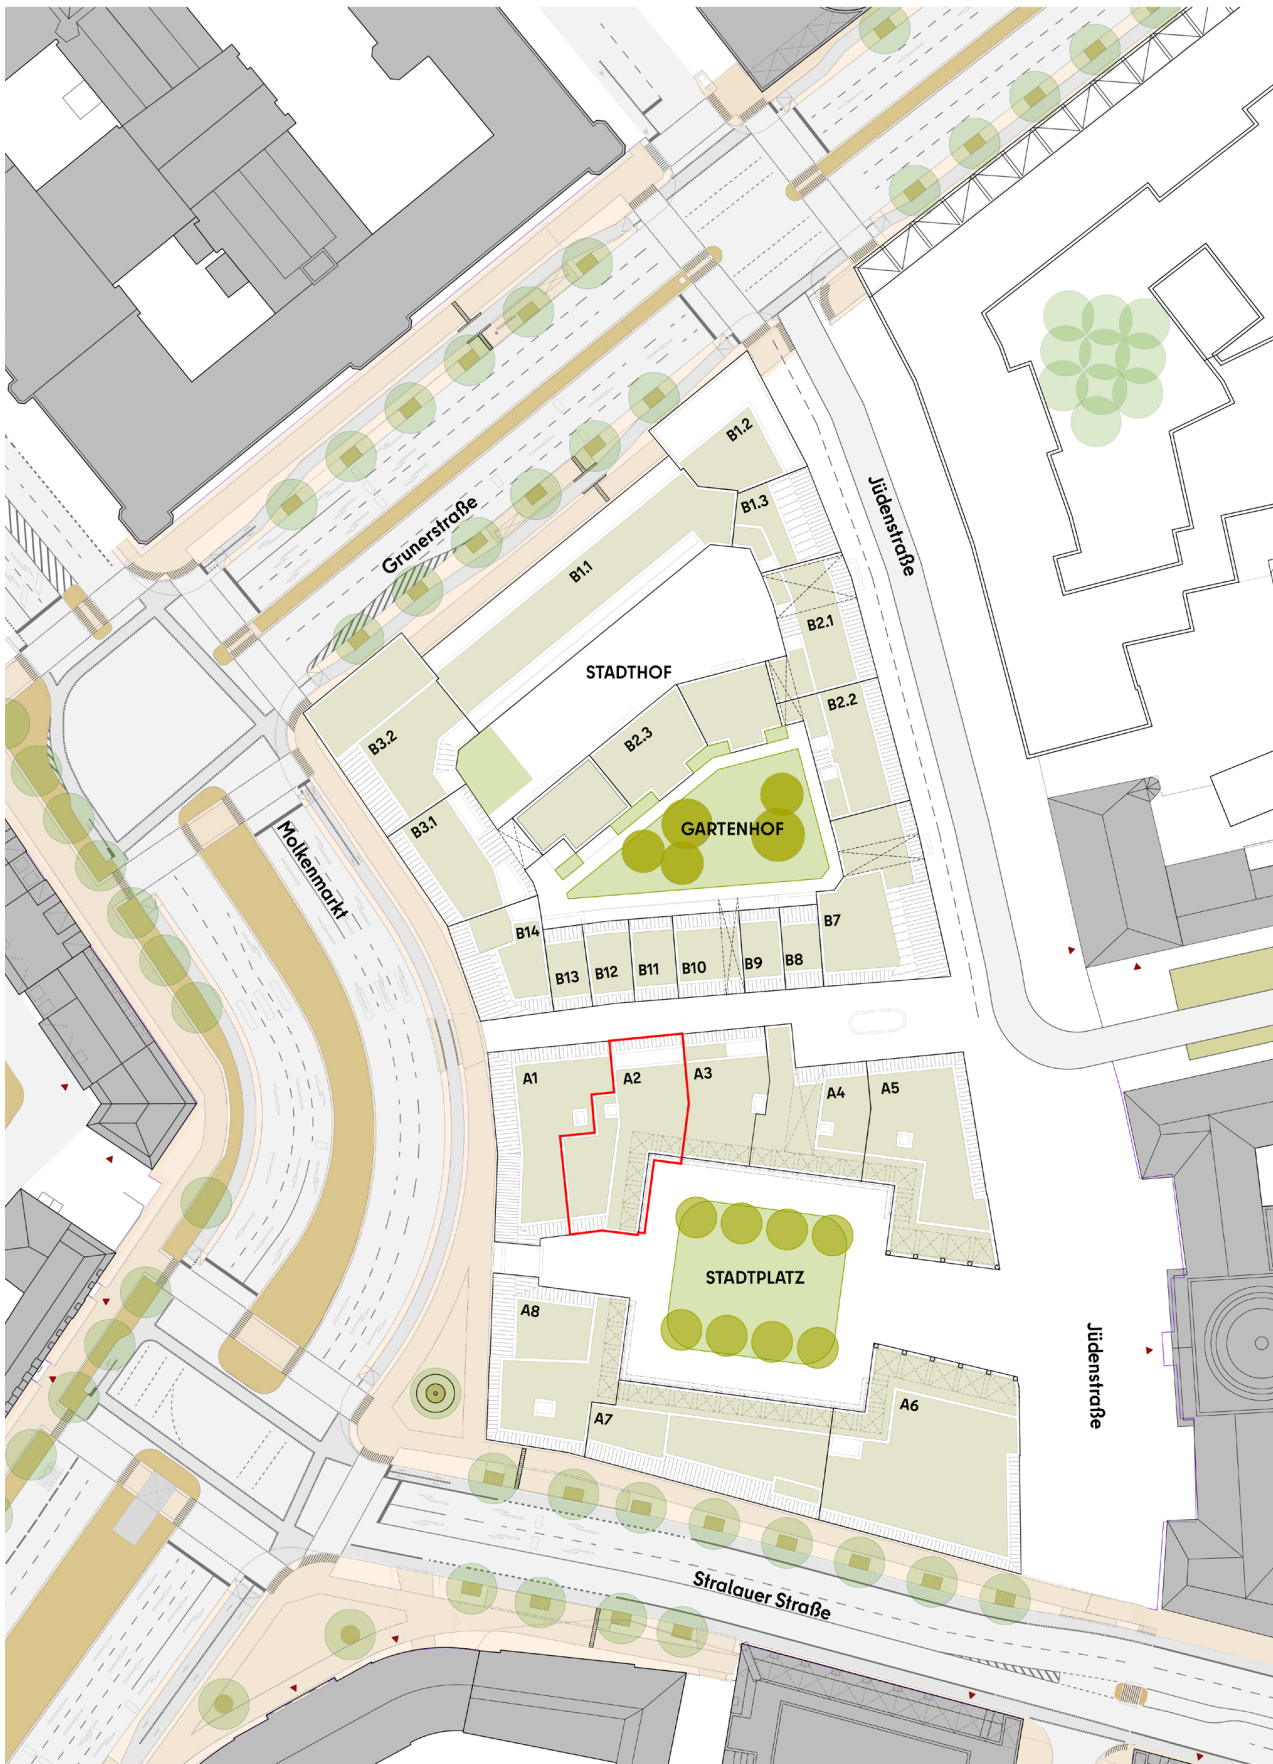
Dachaufsicht Block A und B mit Lage Haus A2
